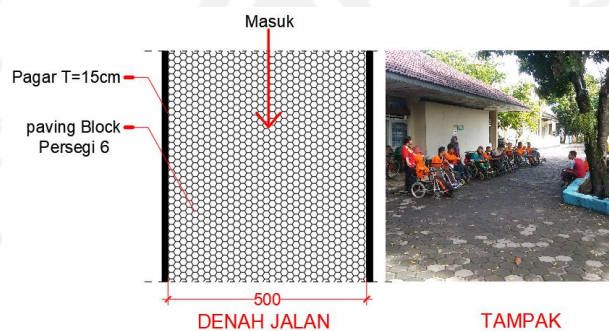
Denah Akses koridor outdoor keliling Jurusan D
